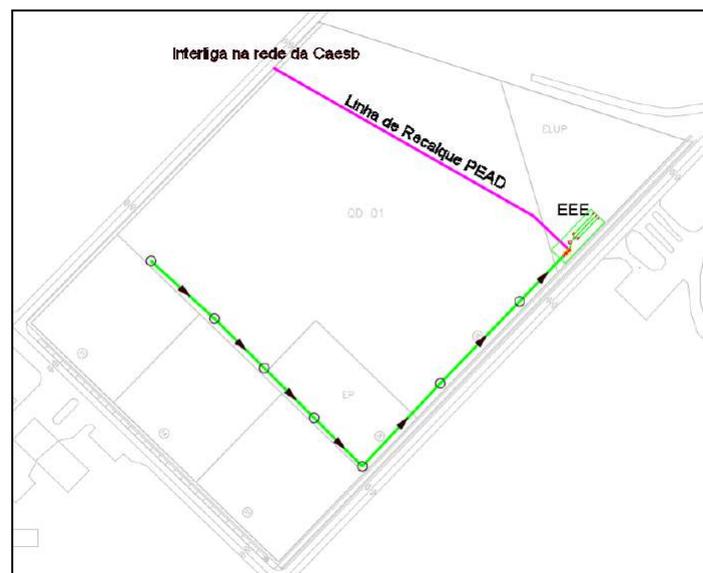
Faixa de Servidão SES - Faixa de servidão PVC < 150 mm.
